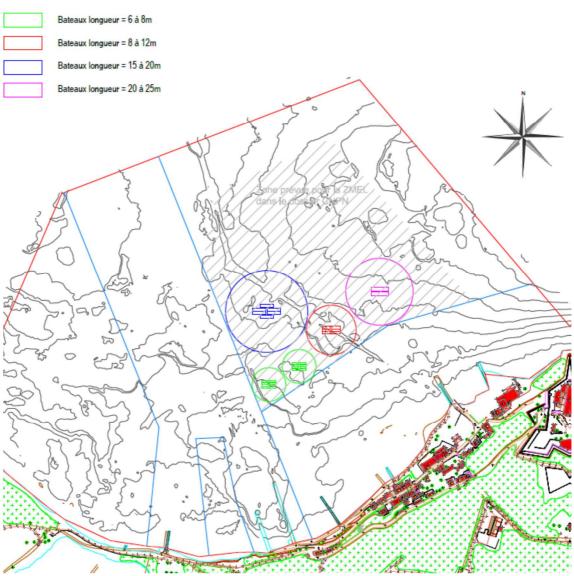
Plan masse du scénario 2 : amarrage sur ponton
